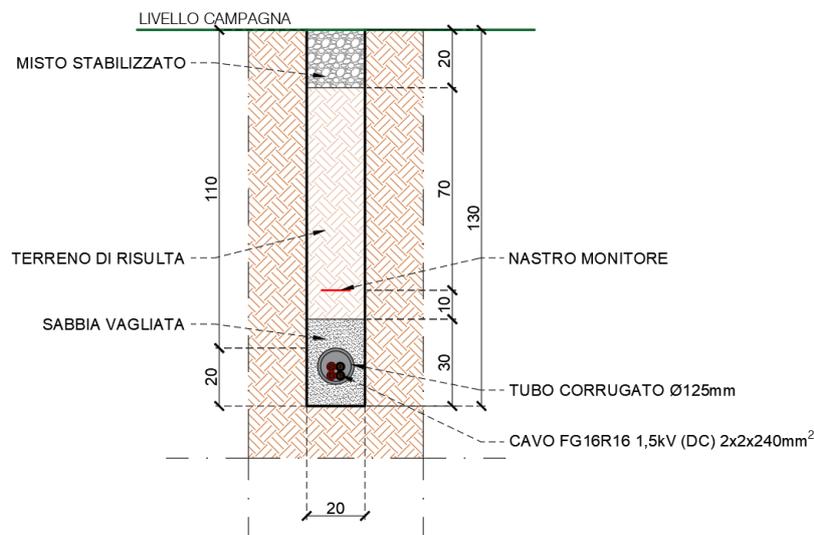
Sezione di scavo cavidotto BT DC (1 linea)
